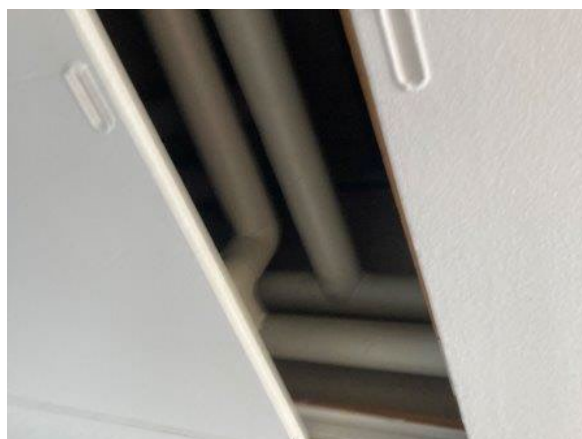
Demonterbart pladeloft, åbnet for inspektion af installationer
